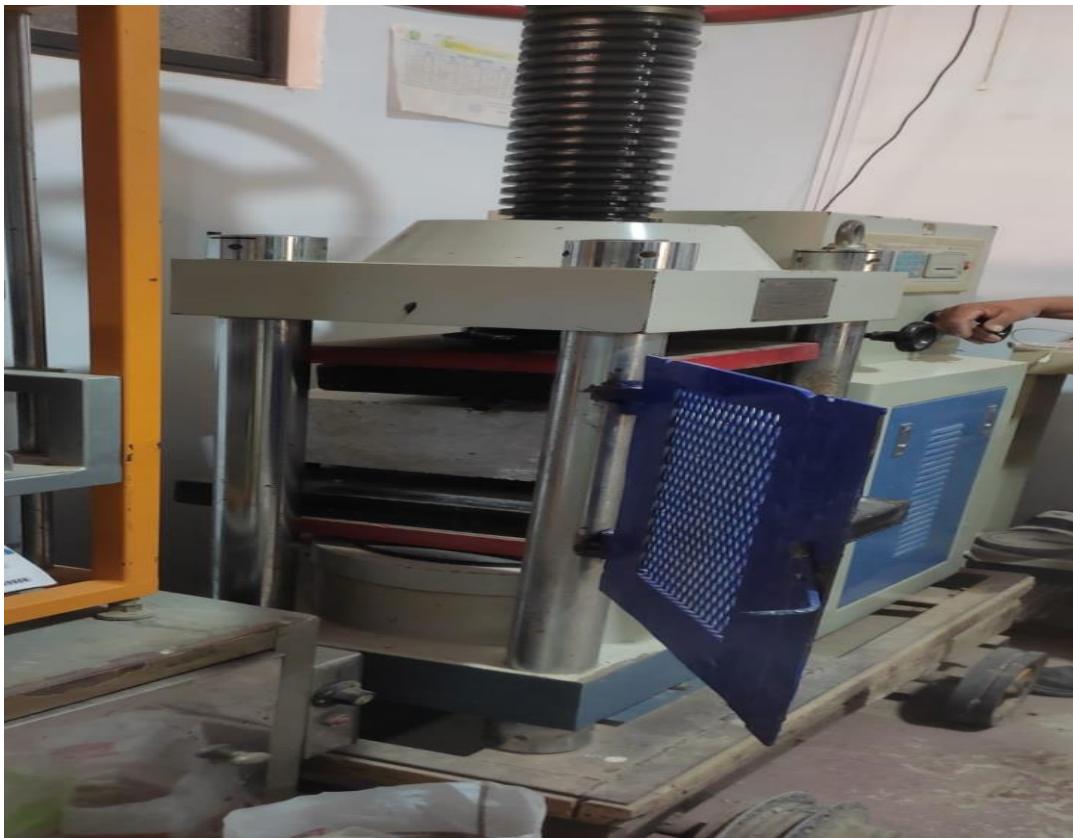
Ensayo de roturas de vigas de concreto 7 y 14 días
